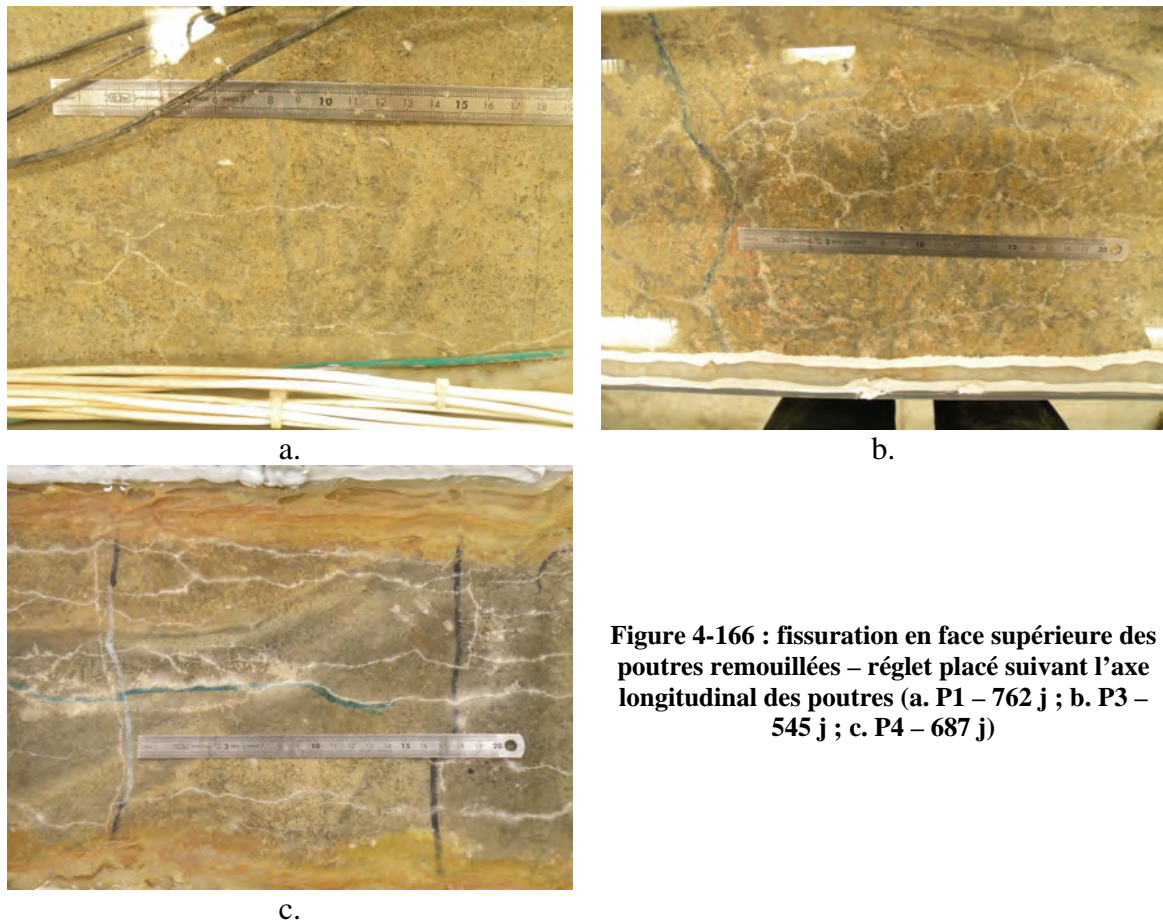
fissuration en face supérieure des poutres remouillées – réglet placé suivant l'axe longitudinal des poutres (a. P1 – 762 j ; b. P3 – 545 j ; c. P4 – 687 j)
